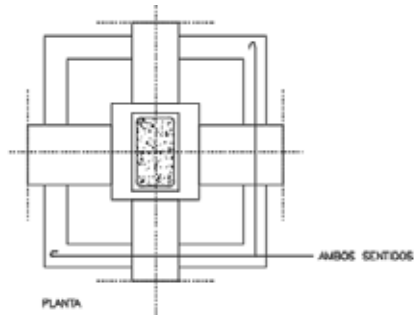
Detalle de Fundación (Planta), fuente: La Autora (2017).
